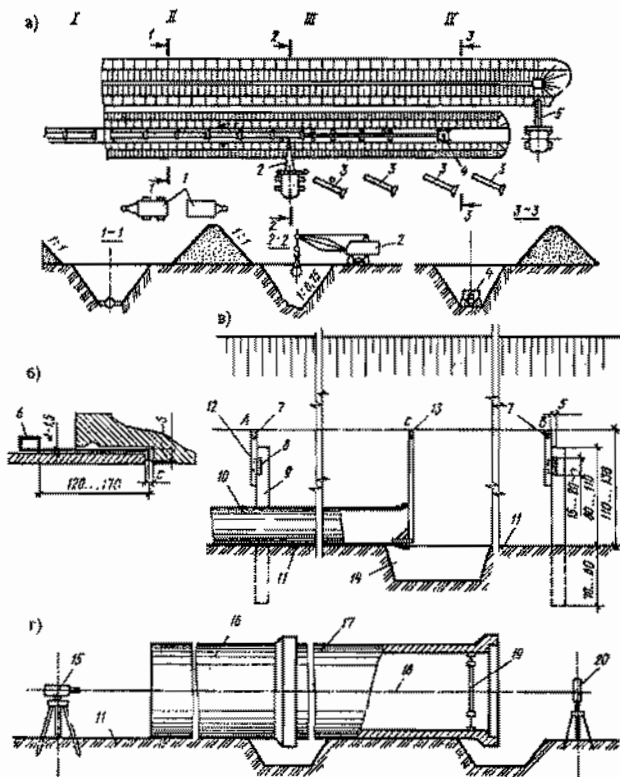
Схема укладки чугунных труб в траншею: 1 - предварительное гидравлическое испытание; II - присыпка грунтом до 0,5 диаметра с уплотнением; III - укладка труб и монтаж; IV - устройство профилированного основания; 1 - передвижные временные здания; 2 - гусеничный кран; 3 - трубы (раскладка); 4 - бульдозер; 5 - экскаватор; 6 - проволочный крюк-шаблон; 7 - постоянная визирка; 8, 9 - доска и столбы обноски; 10 - труба; 11 - дно траншеи; 12 - полочка; 13 - ходовая визирка; 14 - приямок для стыкования труб; 15 - лазерный нивелир; 16 - уложенная труба; 17 - укладываемая труба; 18 - ось трубопровода (луч лазерного нивелира); 19 - полупрозрачный экран для центрирования луча; 20 - экран
